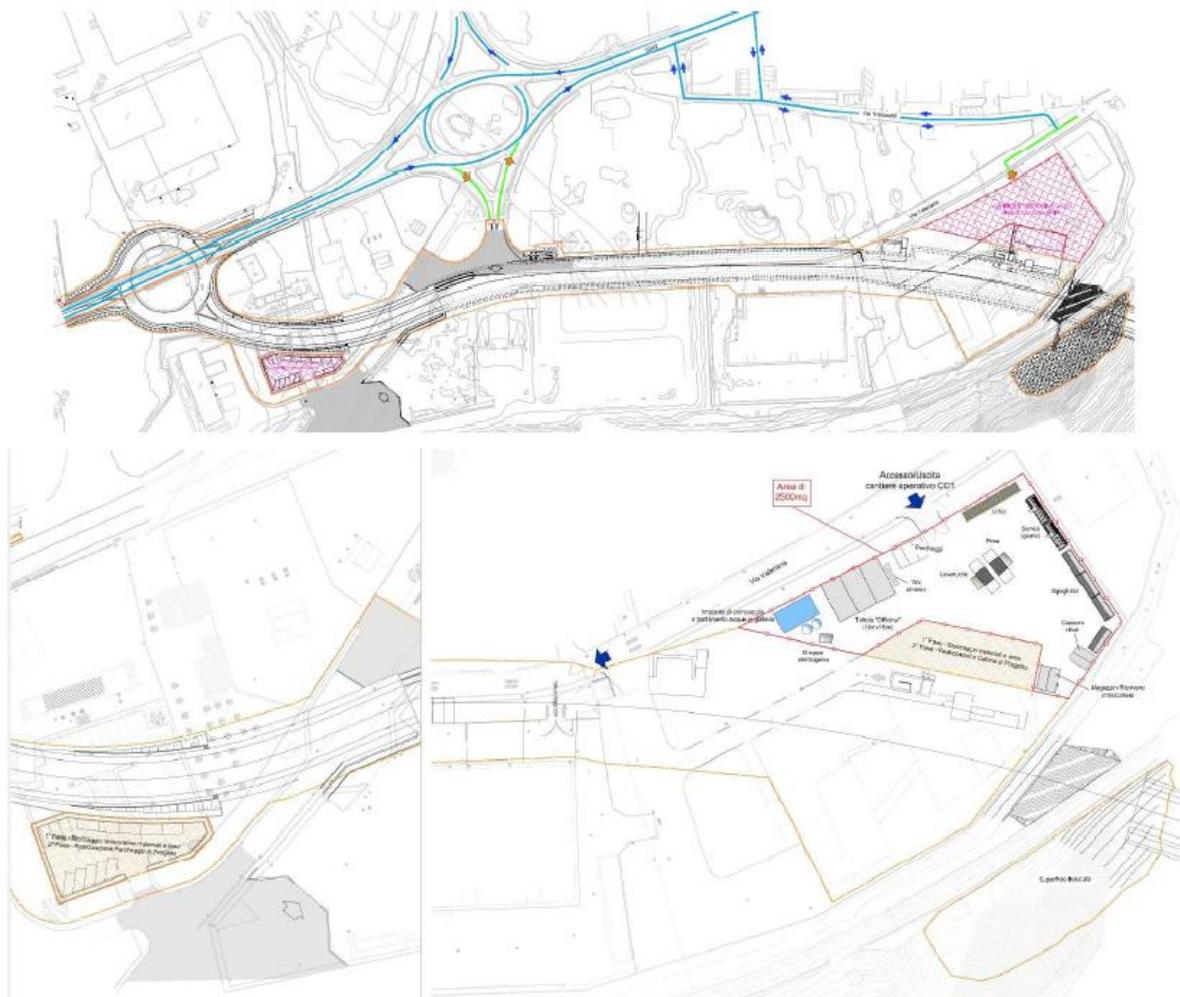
Campo operativo n. 1 (Sud) – Planimetria
